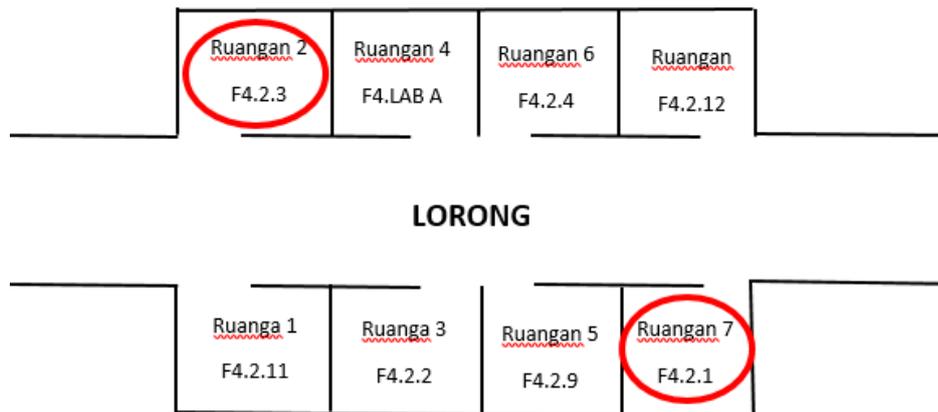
1 Denah Lantai Dasar F4 UMY
